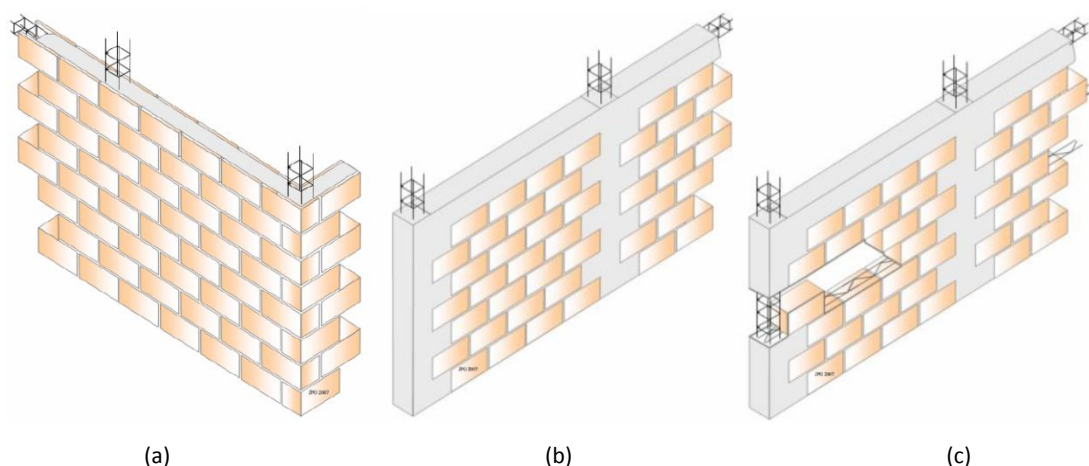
Exemplo de estruturas de alvenaria confinada; (a) Alvenaria confinada com unidades de alvenaria específicas; (b) Alvenaria confinada com elementos de betão armado de face à vista; (c) Alvenaria confinada com armadura de junta horizontal, (reproduzido de Gouveia et al., 2007).
